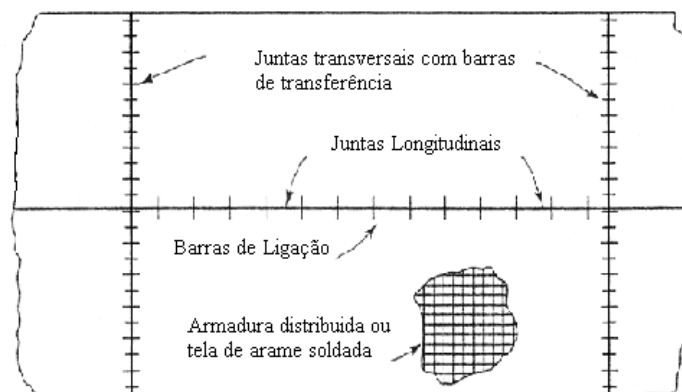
Armadura e juntas em pavimentos de concreto (Huang, 2004)
